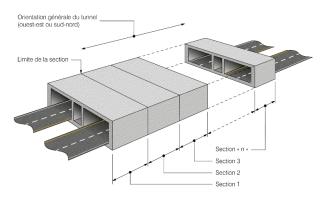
Sectionnement d'un tunnel selon l'orientation générale de la route
